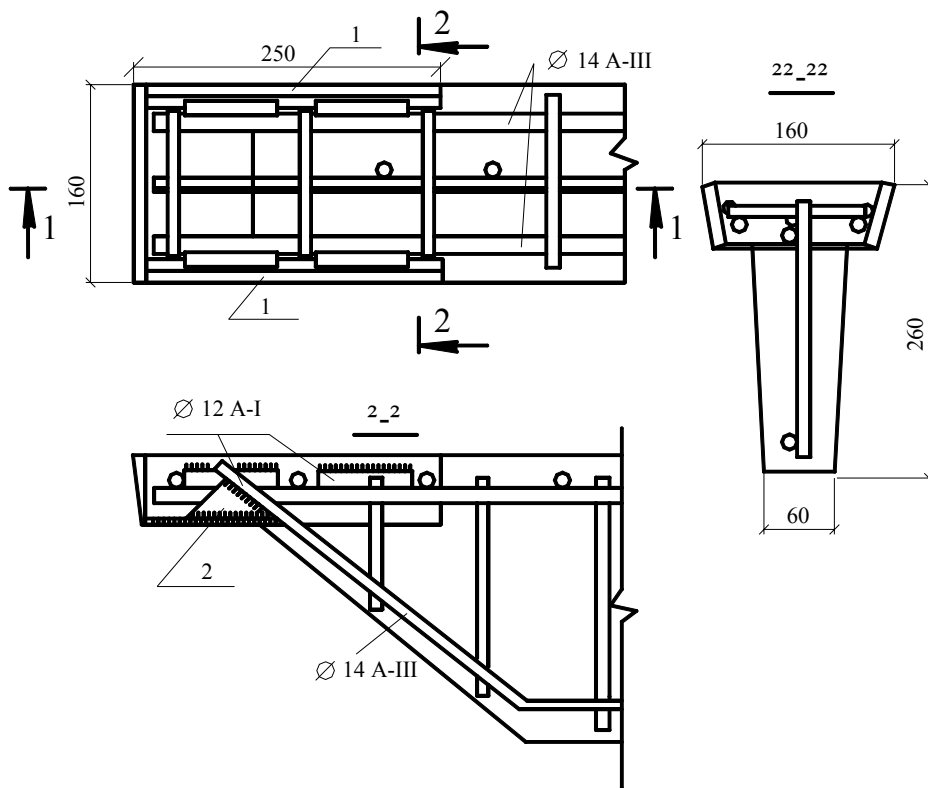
Армування опорного вузла прогону ПЖТ 6-500:
